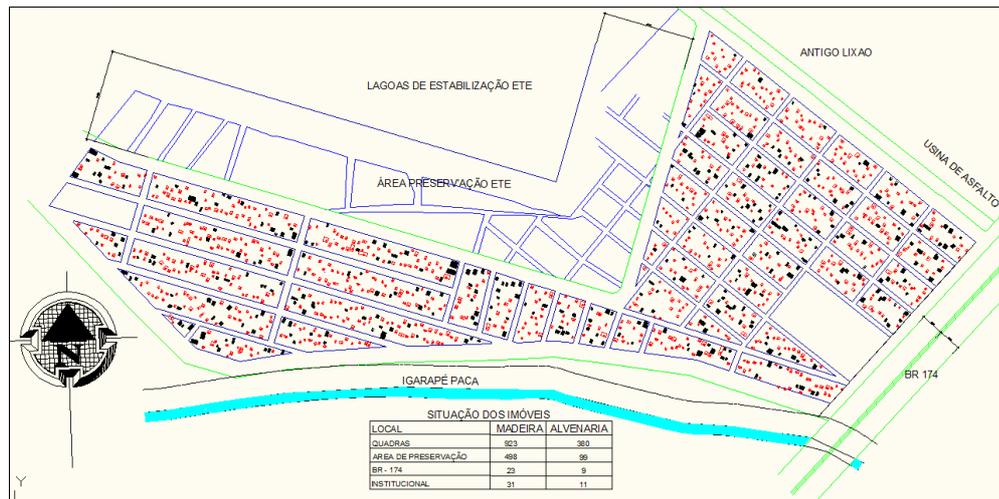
Planta do levantamento das construções existentes de alvenaria (preto) e de madeira (vermelho), situadas na área passível de regularização – 2007
